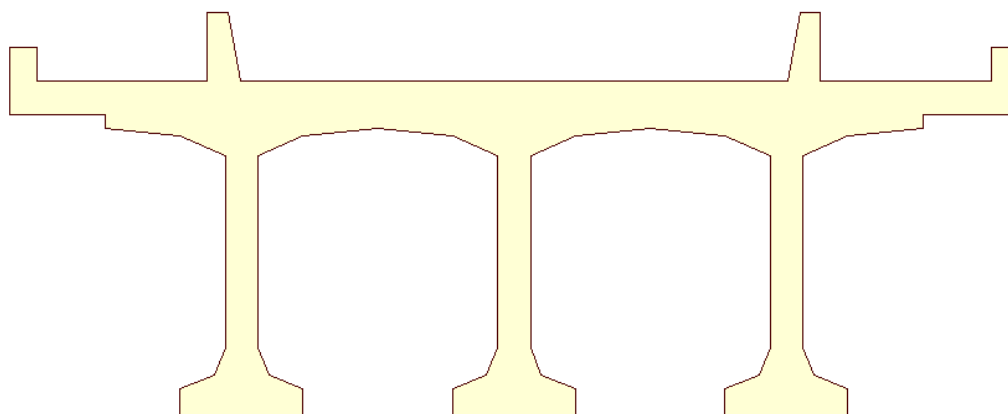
Modellazione dell'impalcato tramite elementi beam unifilari
